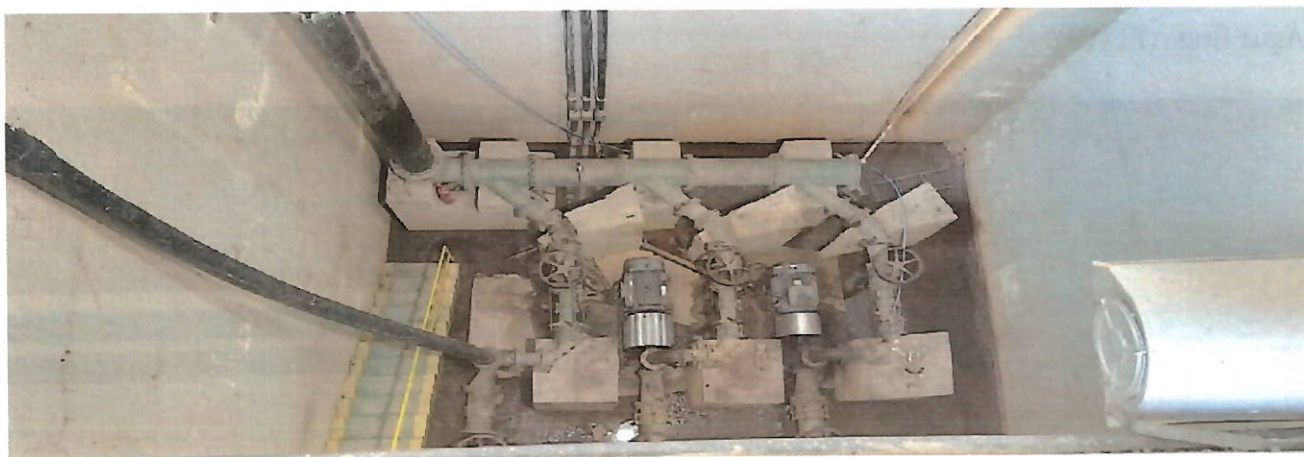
Instalações de bombeamento da EEAB Paraquena.
